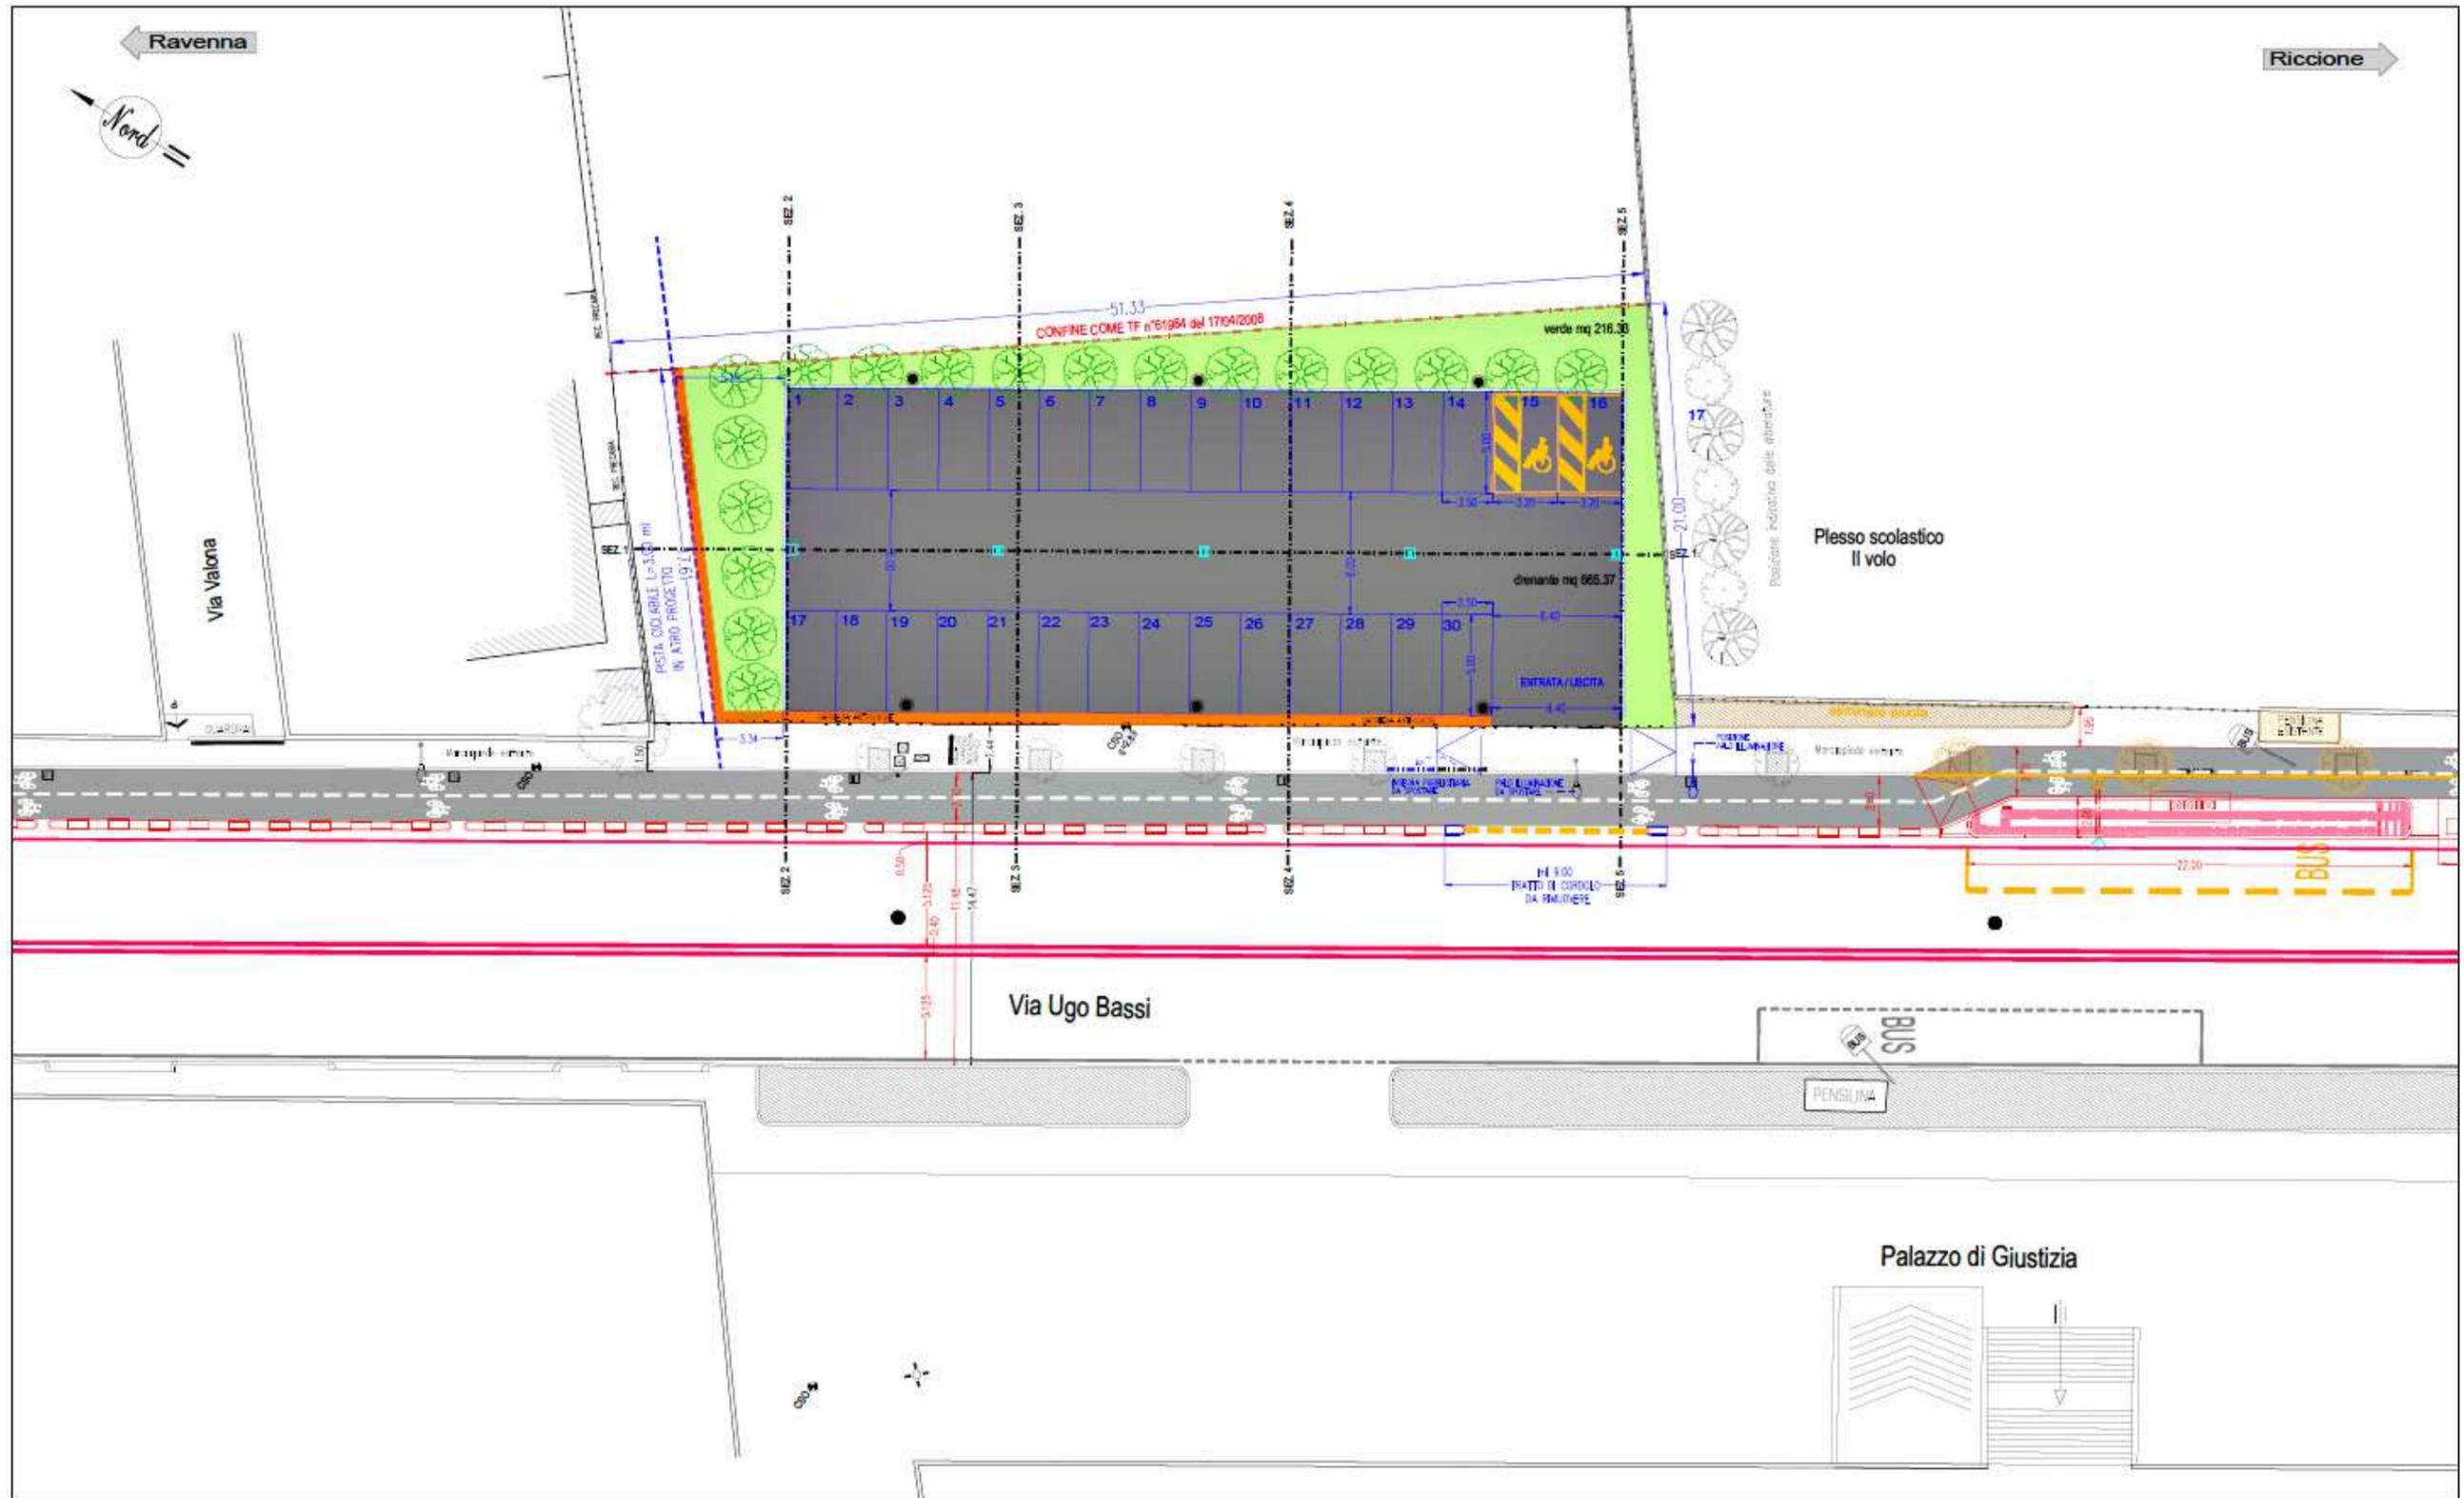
planimetria progetto parcheggio Kiss and Ride
